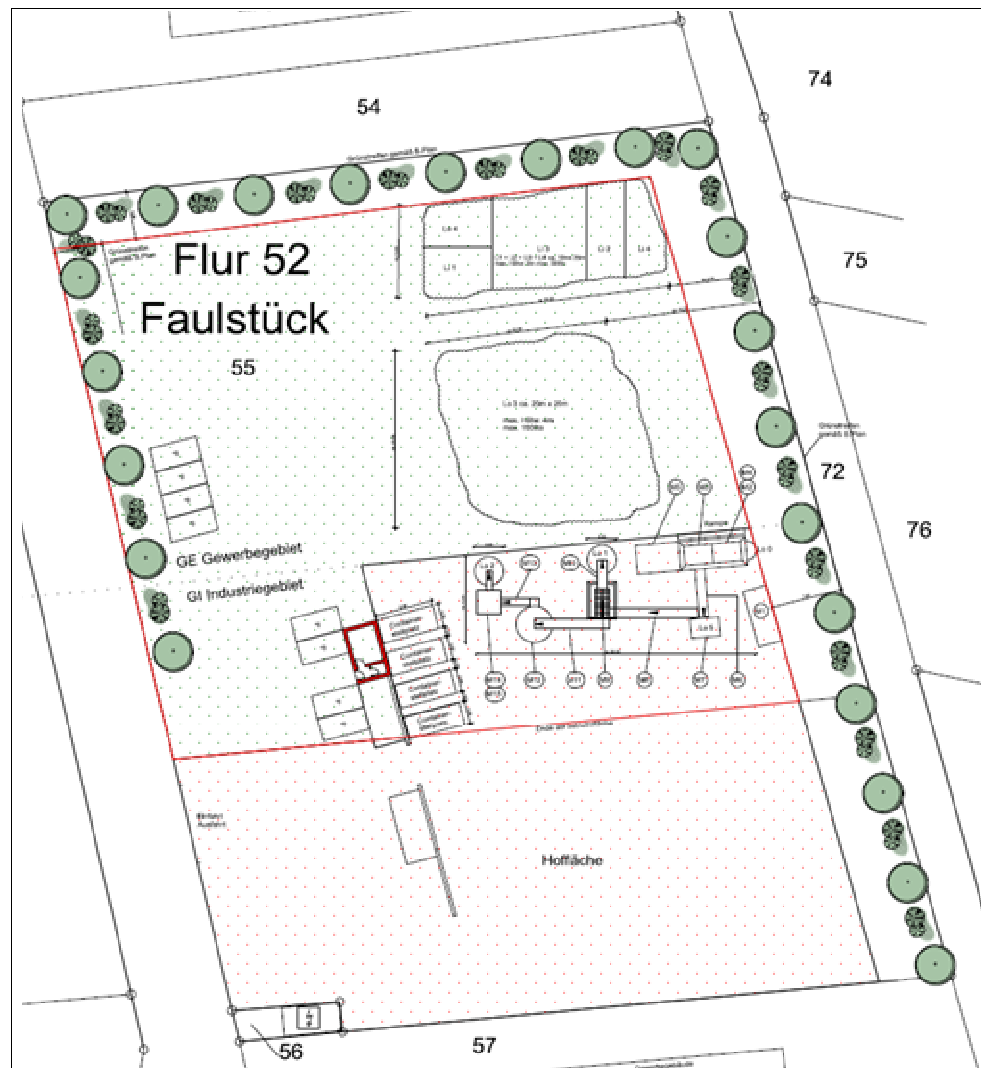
Lageplan des Betriebsgeländes (ohne Maßstab, eingenordet).
